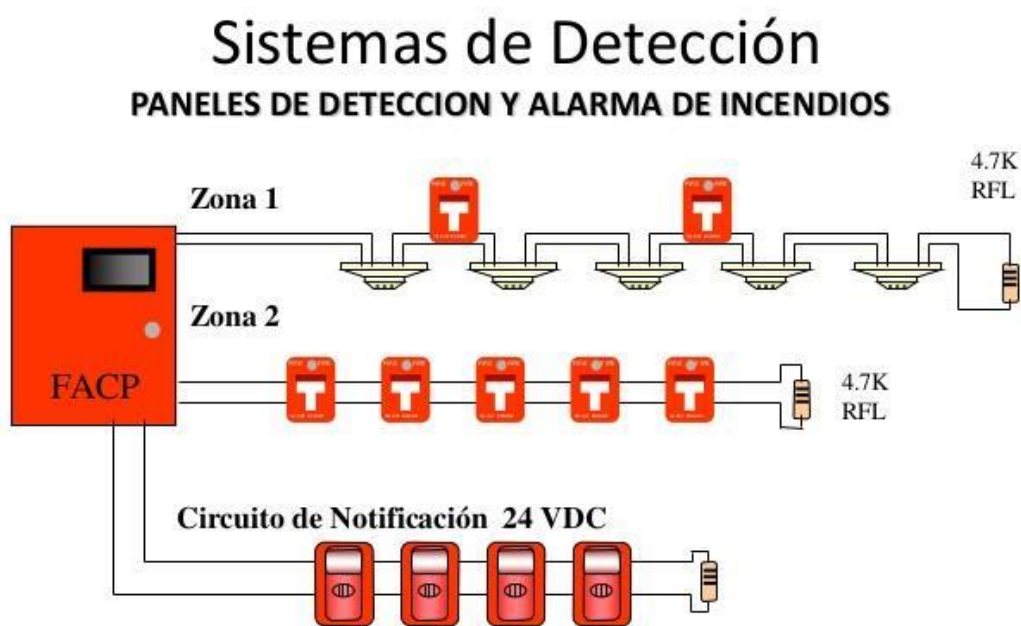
Sistema de detección. Fuente: Elaboración propia.
